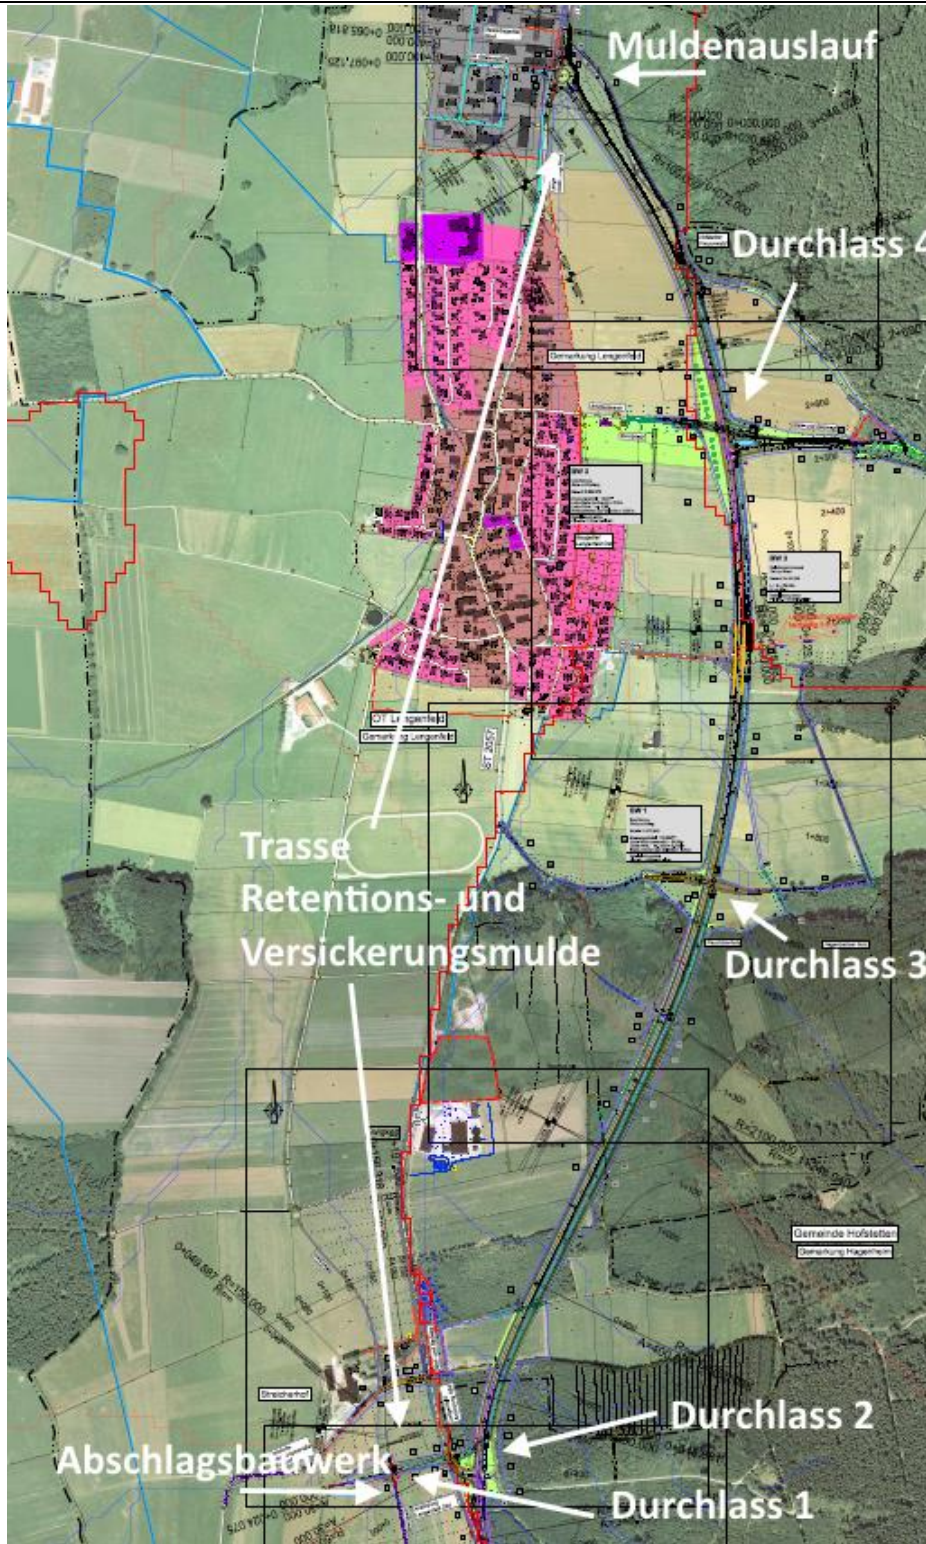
Ausschnitt Lageplan mit der geplanten Retentions- und Versickerungsmulde und den notwendigen Durchlässen
